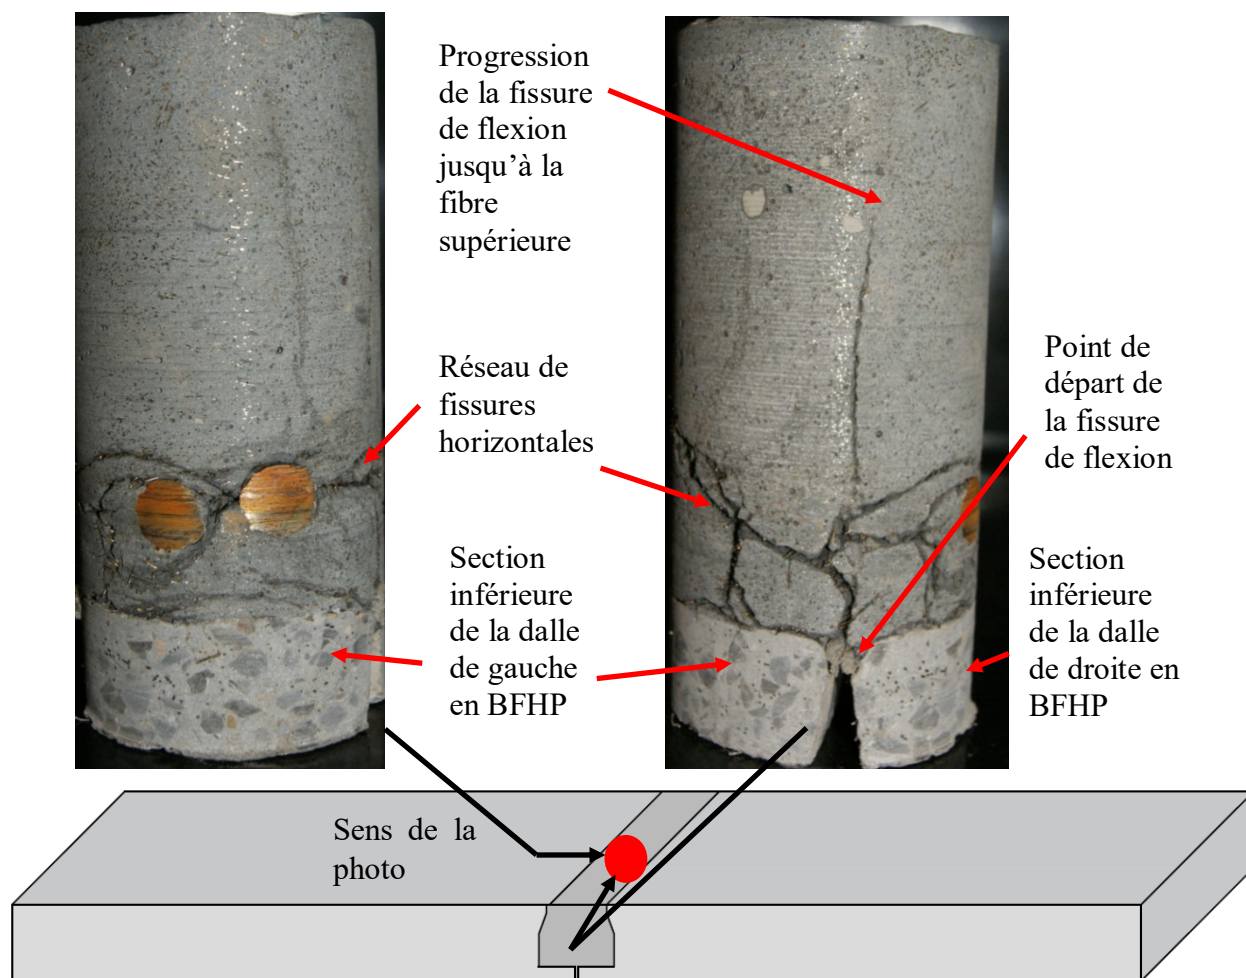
Carottage de la dalle en BFHP avec joint de connexion longitudinal de 175 mm
